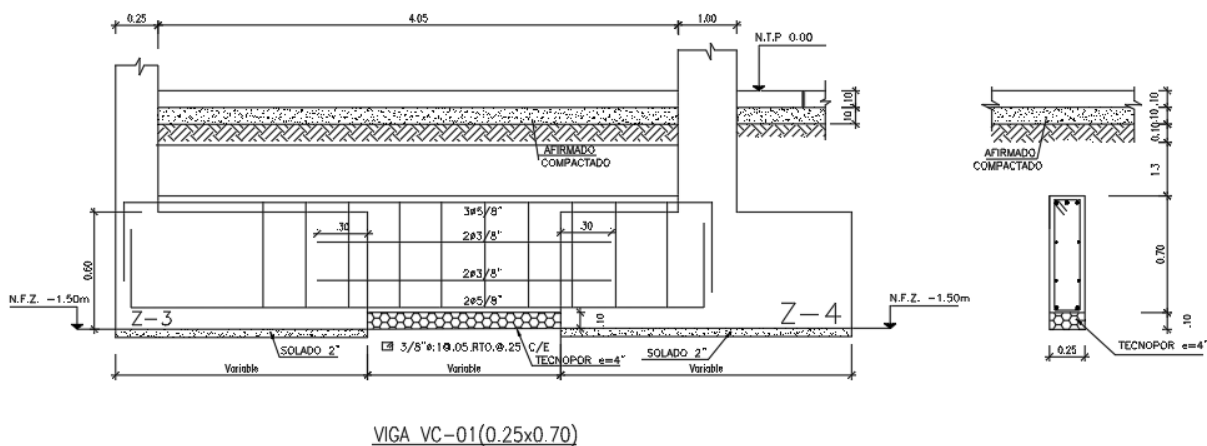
Distribución de refuerzos final de viga de cimentación (vista en planta)
